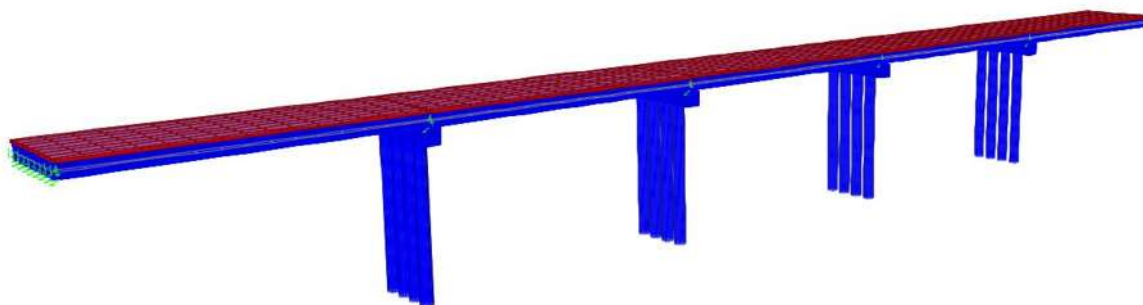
Elementos Shell (rojo) y elementos tipo barra (azul).
